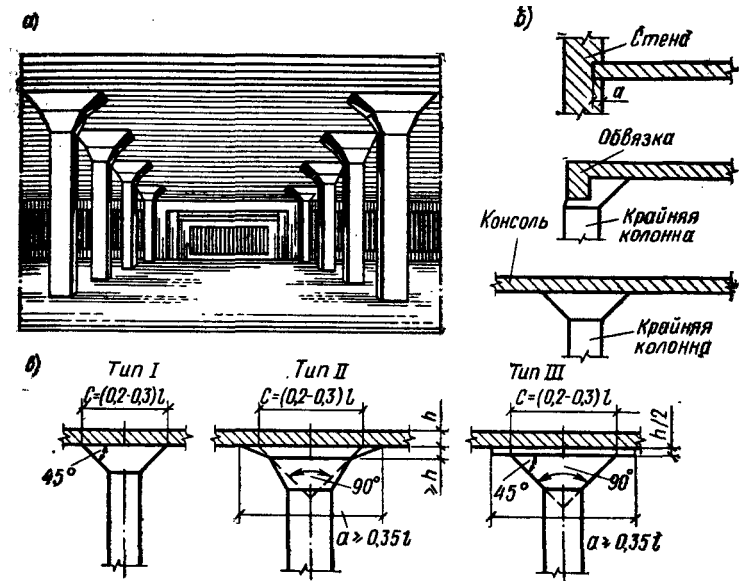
Конструкция безбалочного монолитного перекрытия
